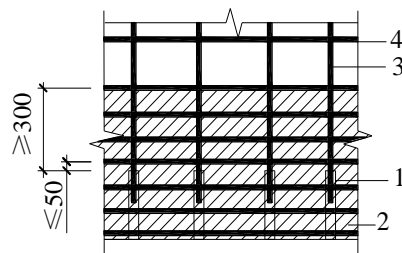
钢筋套筒灌浆连接部位水平分布钢筋的加密构造示意
